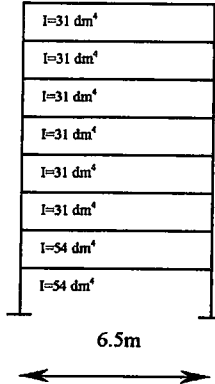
Rijit kolonlu çerçeve tipi yapının kolon ve kiriş rijitlikleri
